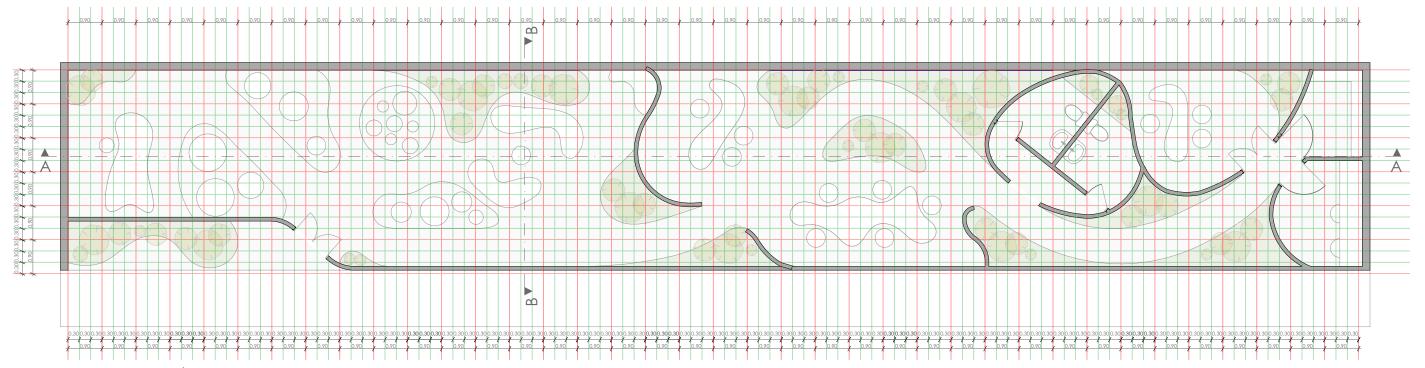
Planta Única. Fuente: Elaborado por el autor. (2025)
